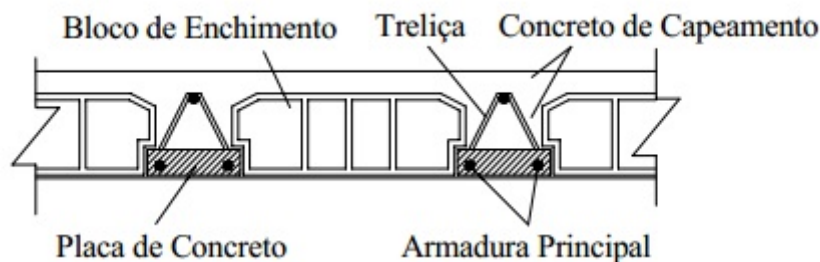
Laje Nervurada Pré-Moldada Treliçada. (Projeto e Construção de Lajes Nervuradas de Concreto Armado. São Carlos, 2005. DA SILVA, Marcos Alberto Ferreira)
